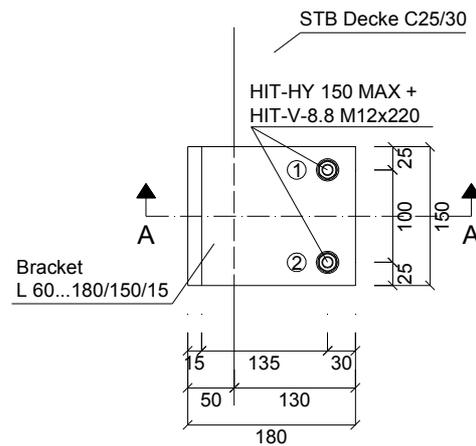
Anschlussdetail F1 Dübel Variante 2 (Maße in mm)
